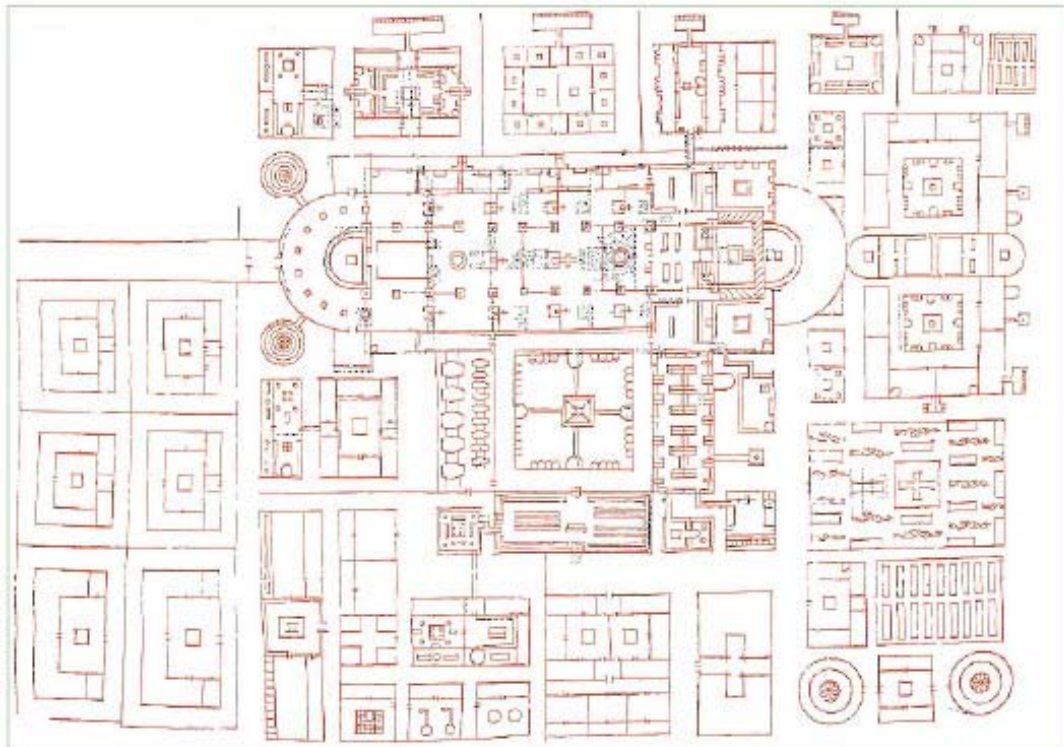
Klosterplan, Rasurlinien und -flächen, nach Jacobsen
